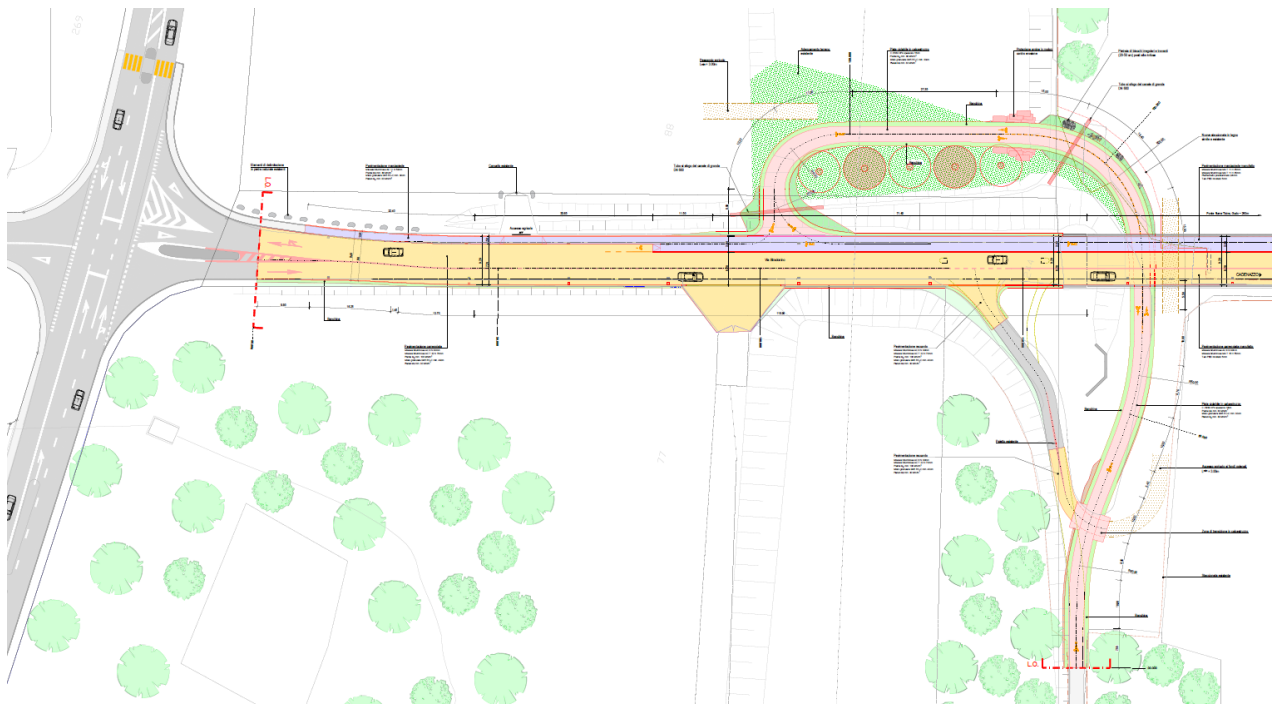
Planimetria di progetto sponda destra, nuovo tracciato di pista ciclabile in alveo
